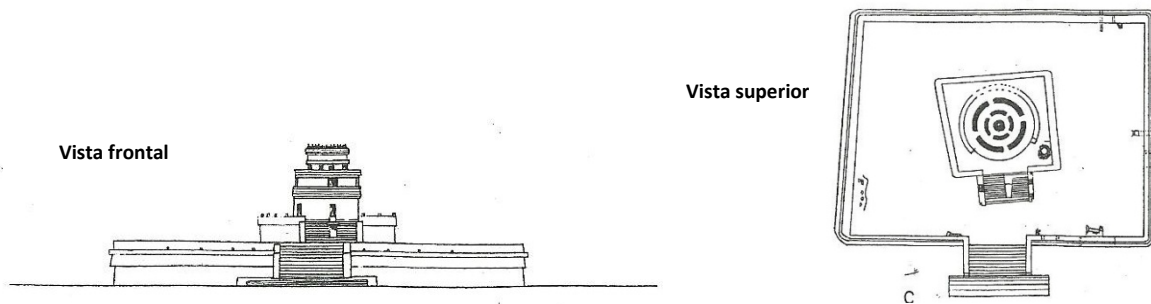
Plano de El Caracol en su última etapa constructiva
